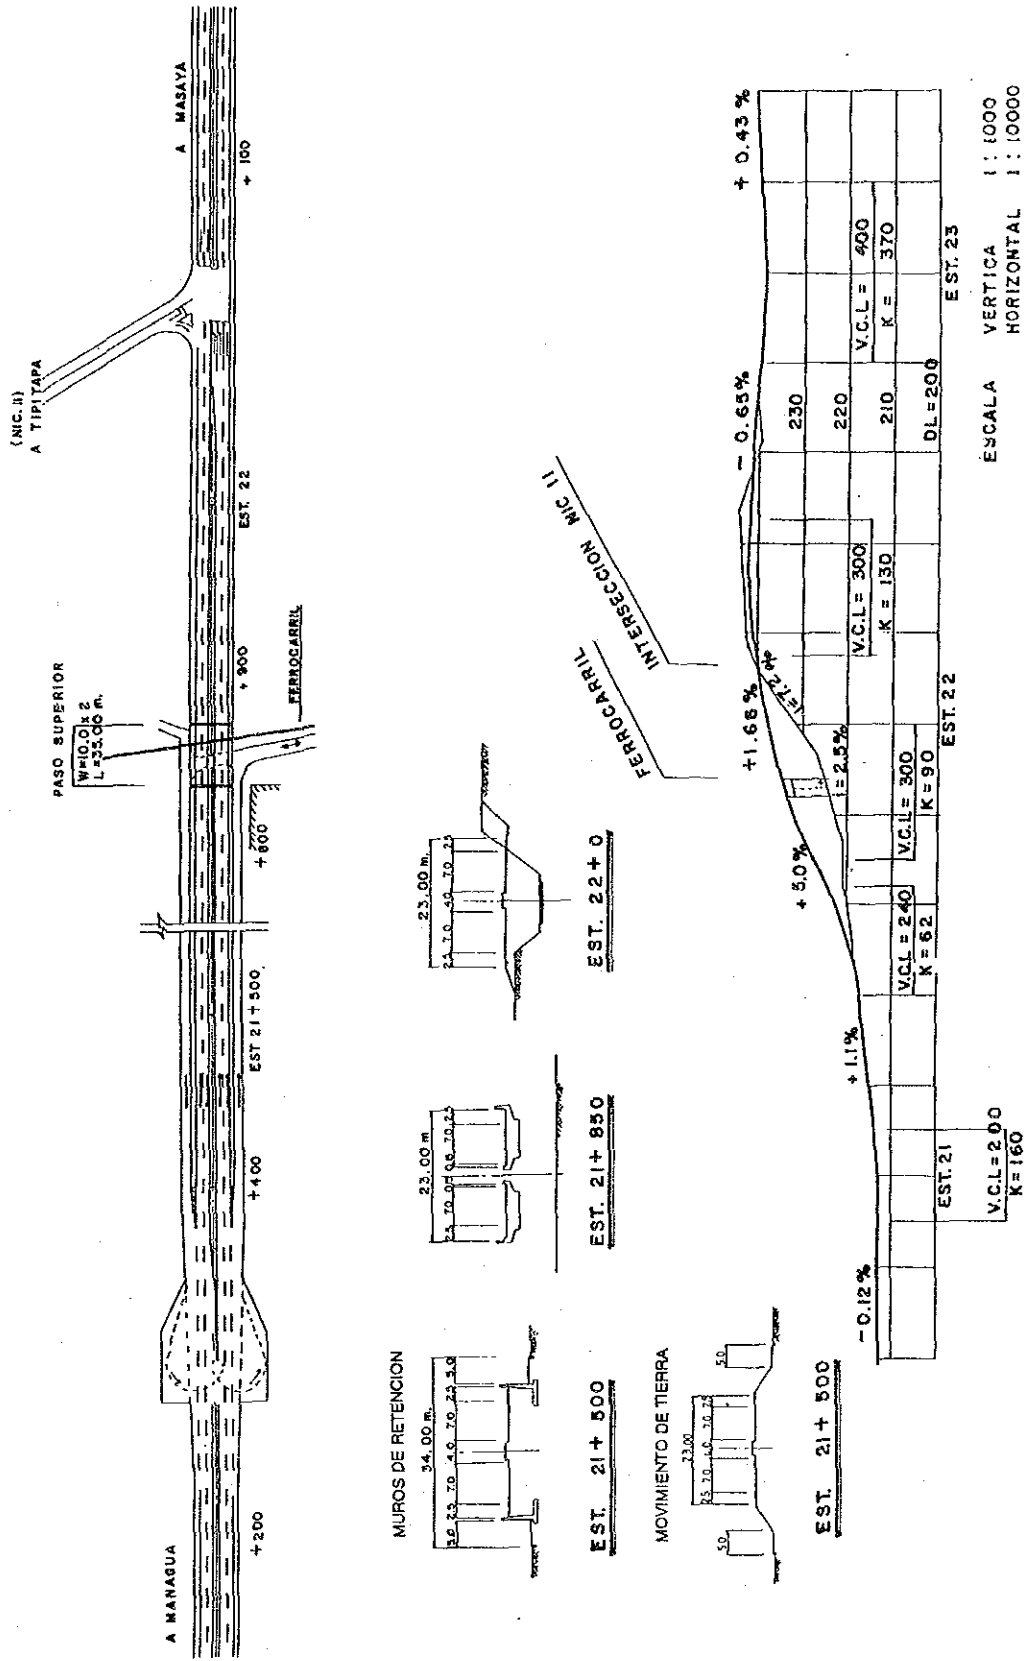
Propuesta de un Nivel Separado de Intersección para Ferrocarril
